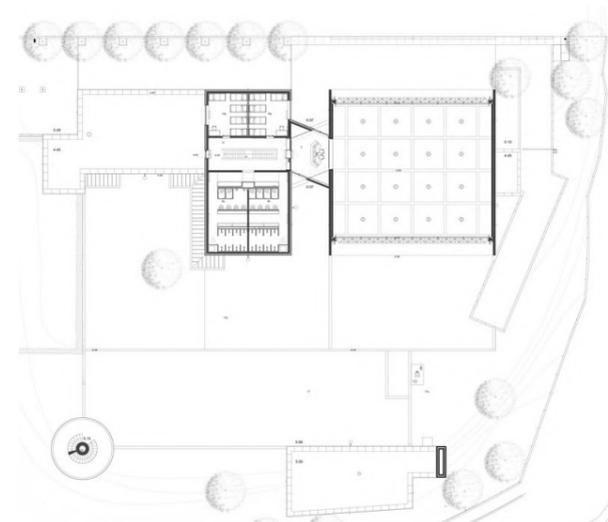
Planta alta estación de Santo Tirso. Fuente: Alvaro Siza
